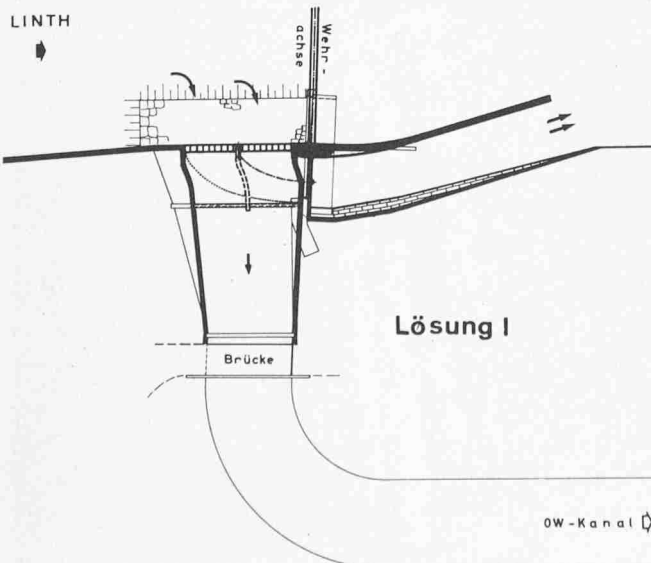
(links). Grundriss der Lösung I der Wasserfassung Mollis/Linth
